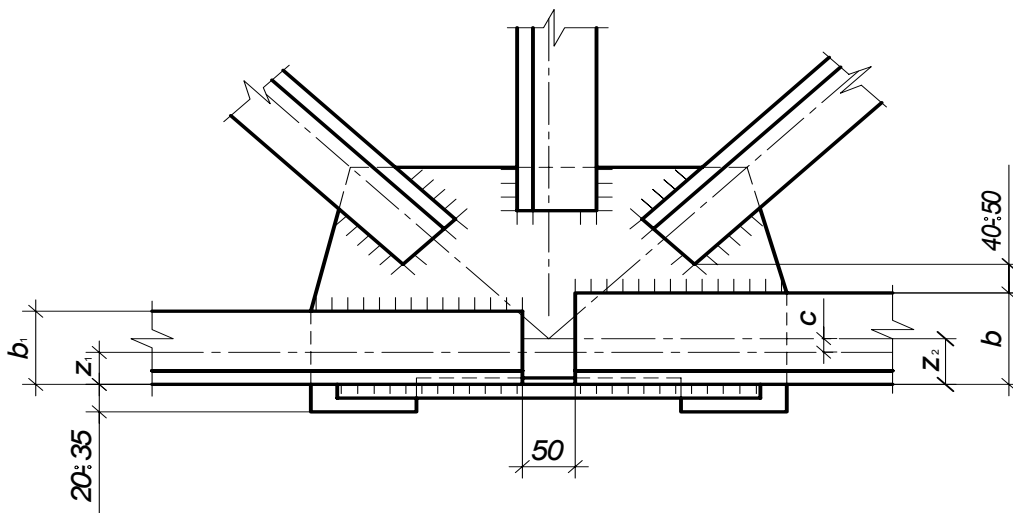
Обеспечение соответствия расчетной и конструктивной схем стропильной фермы
